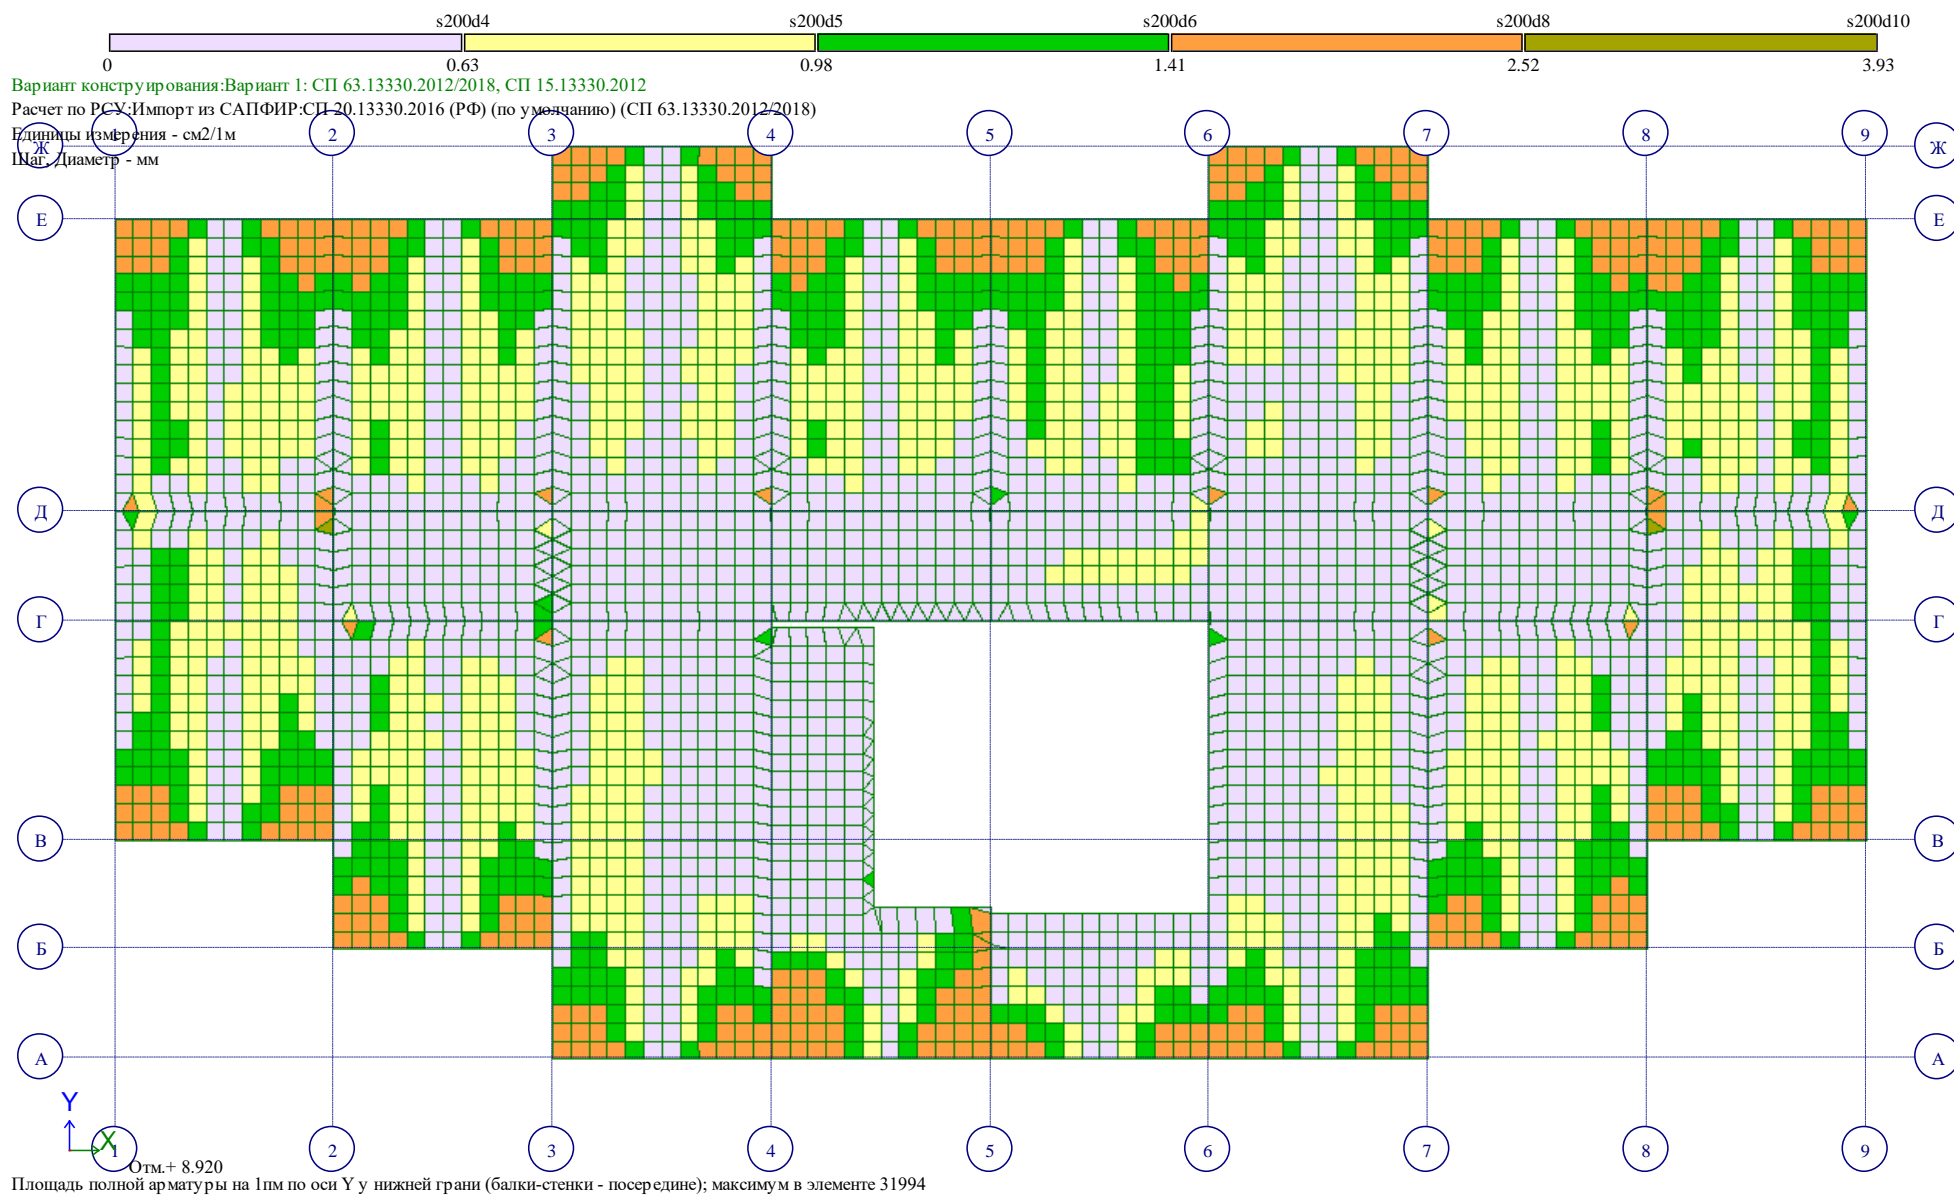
Площадь полной арматуры на 1пм по оси Y у нижней грани
